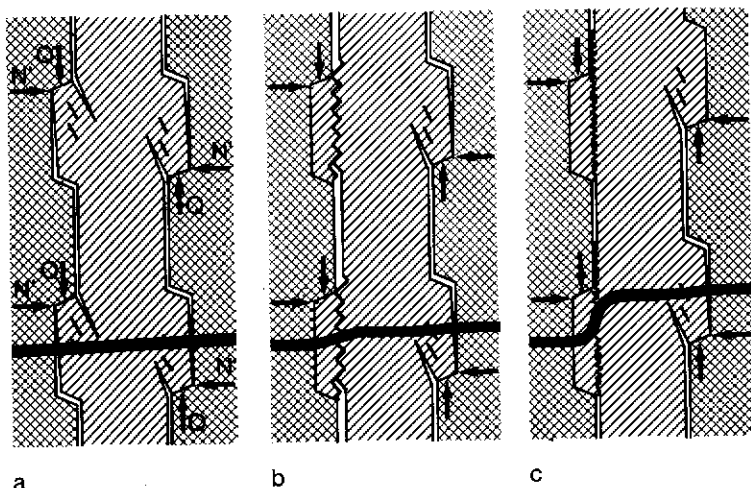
Et typisk etagekryds mellem betondæk og -vægelementer rummer fire forskellige langsgående støbeskel:
